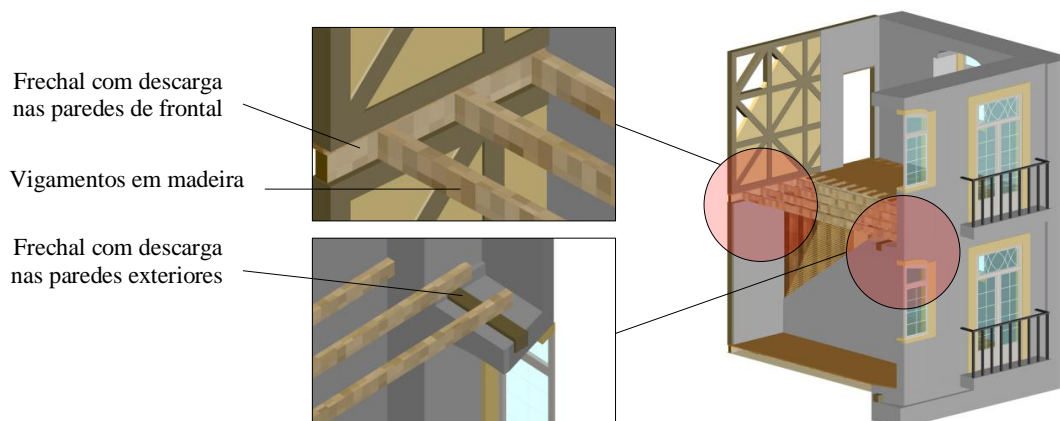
Frechais de apoio aos vigamentos do pavimento e a descarga nas paredes de frontal (interiores) e paredes exteriores.
